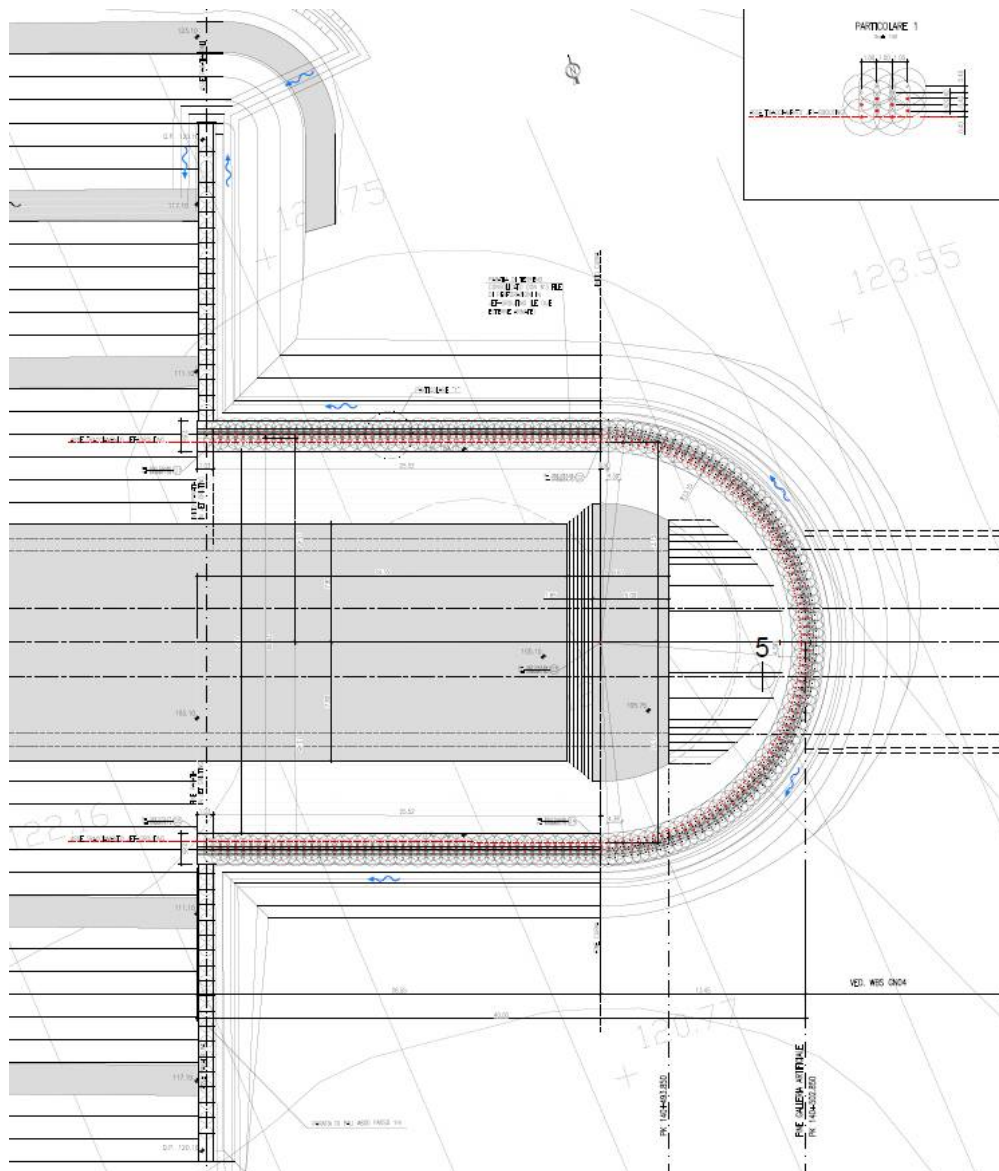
Vista in pianta della paratia in jet grouting all'imbocco lato Milano GI08.
